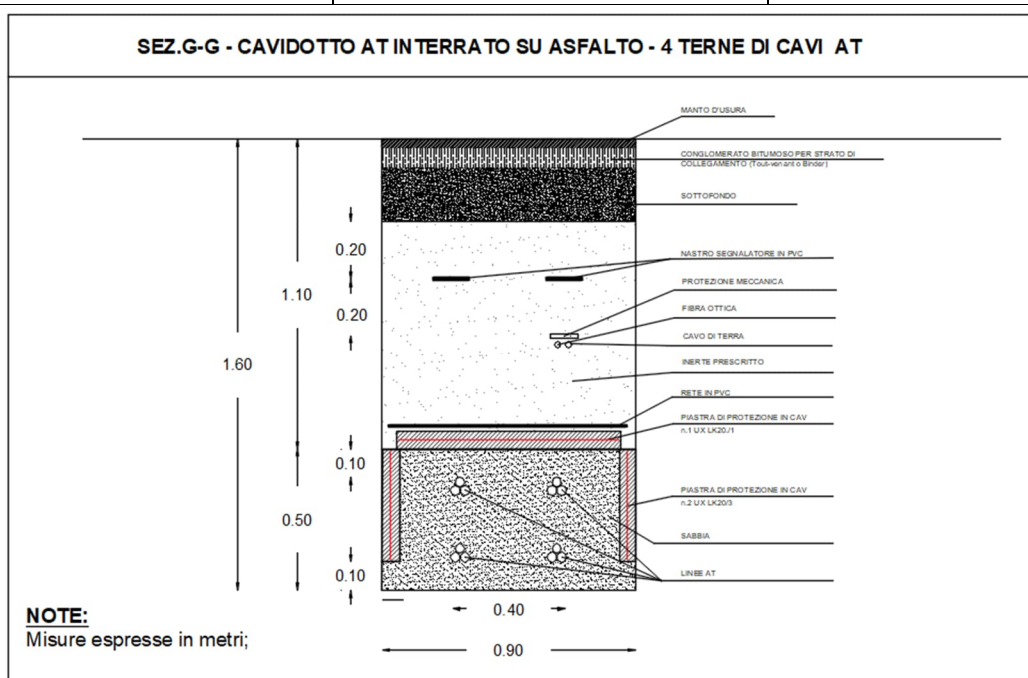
Stralcio elaborato “ROC.ENG.TAV.022_Planimetria dei cavidotti con indicazione delle sezioni di posa” – Sezioni per interrimento del cavidotto AT
